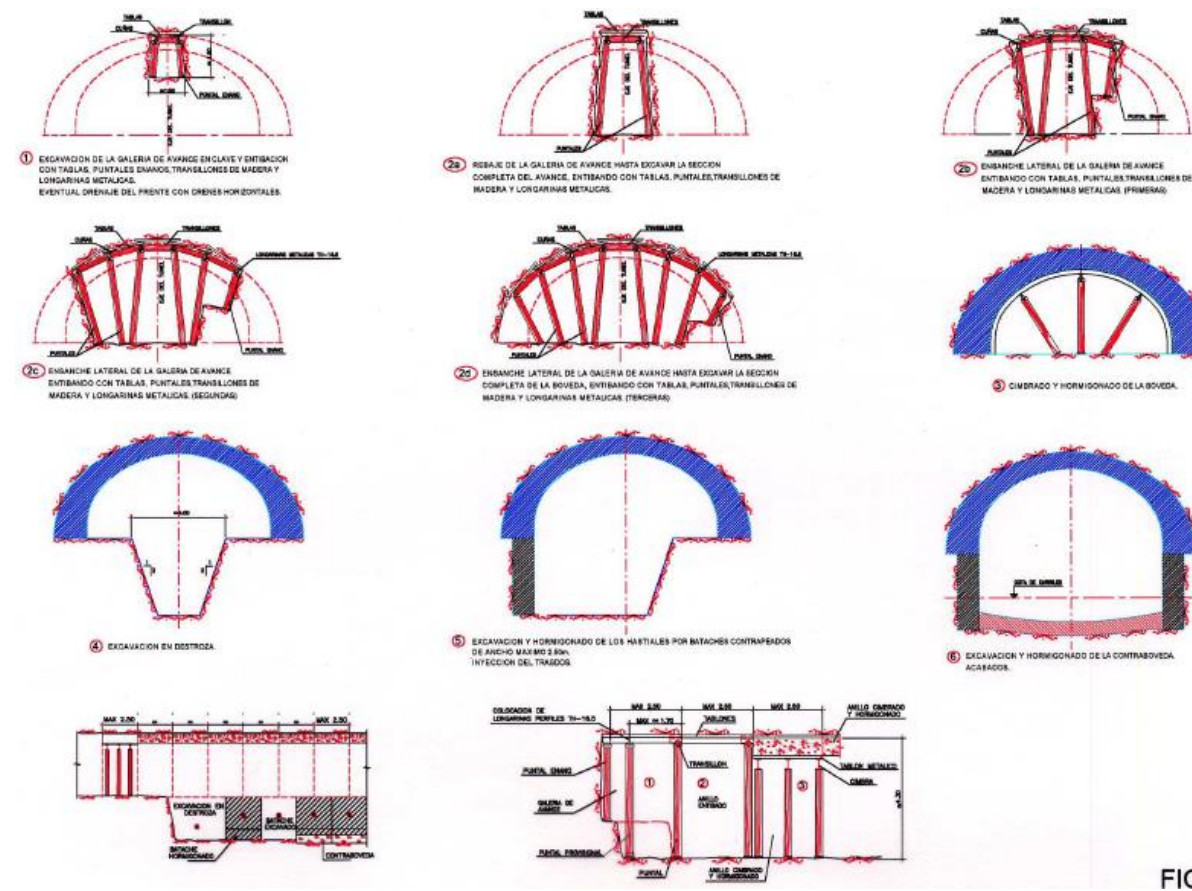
Fases constructivas habitualmente utilizadas en el Método Tradicional de Madrid.
